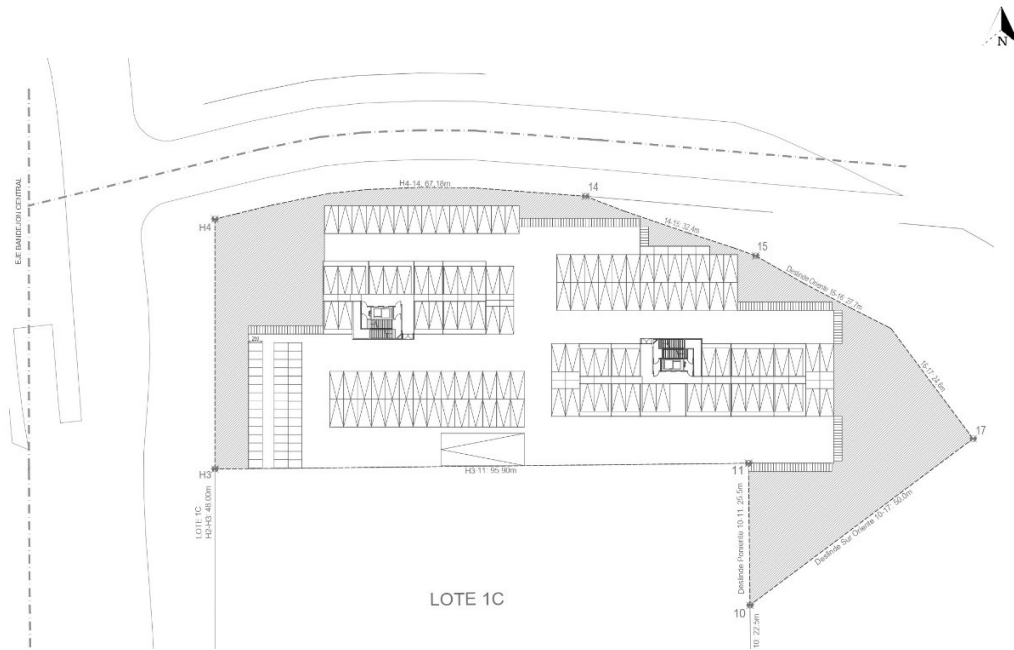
Plano tipo subterráneo (Sin escala). Fuente Elaboración propia.
